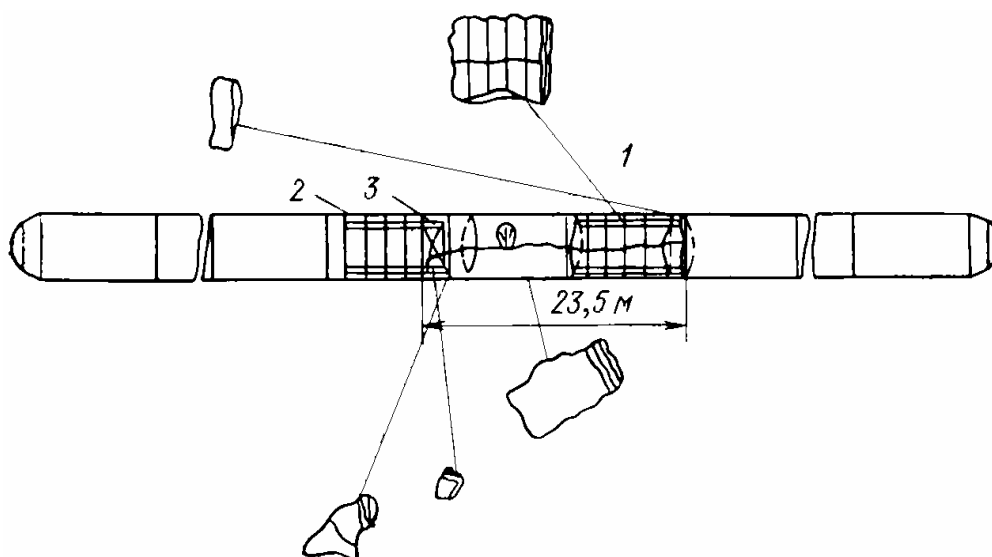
Схема руйнування відрізка газопроводу довжиною 150 м із багатошарових труб розмірами 1420х(4.3х4) мм із сталі 09Г2СФ
